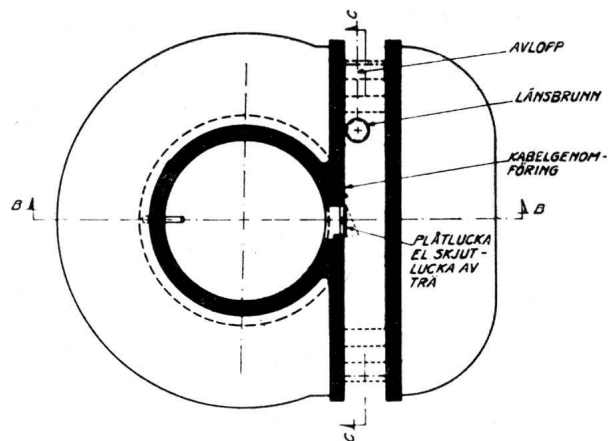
Grundriss A-A. Avlopp = Ablauf, länsbrunn = Entleerungsschacht, kabelgenomföring = Kabeleinführung, Plåtlucka al. skjutlucka av trä = Bleiklappe oder Schliessluke aus Holz.
